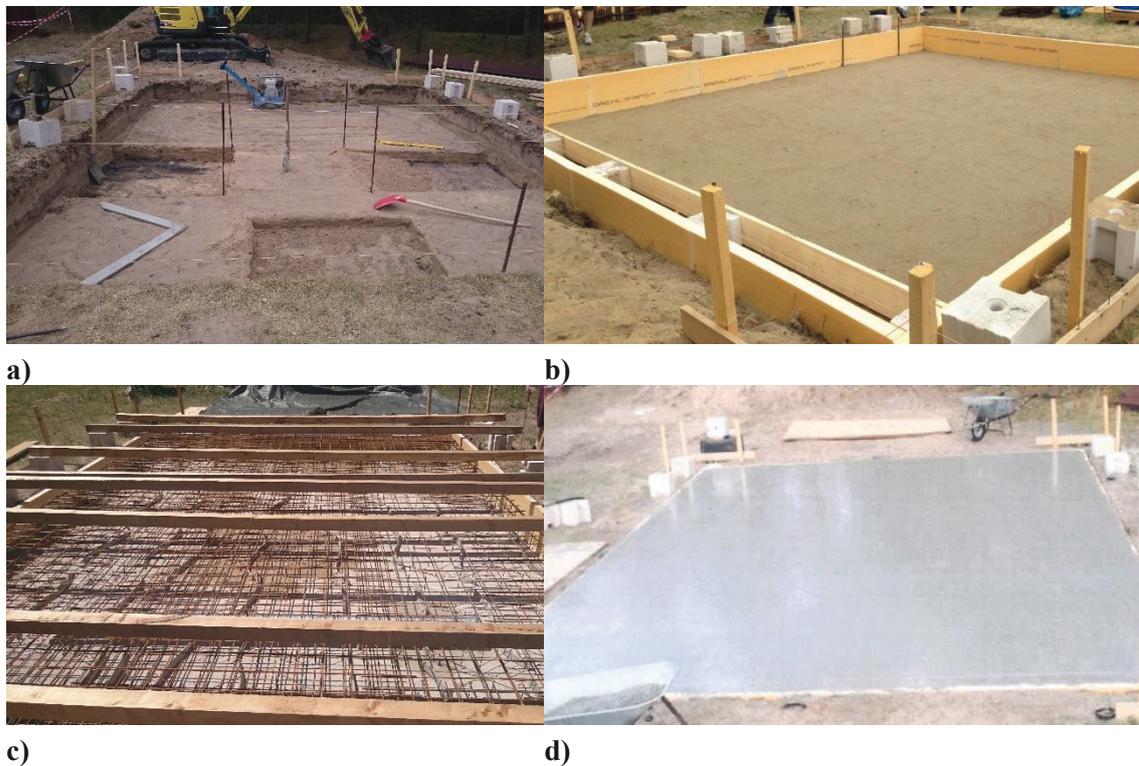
Erdmodell, Sauberkeitsschicht, Bewehrung und Fundament (a-d)
